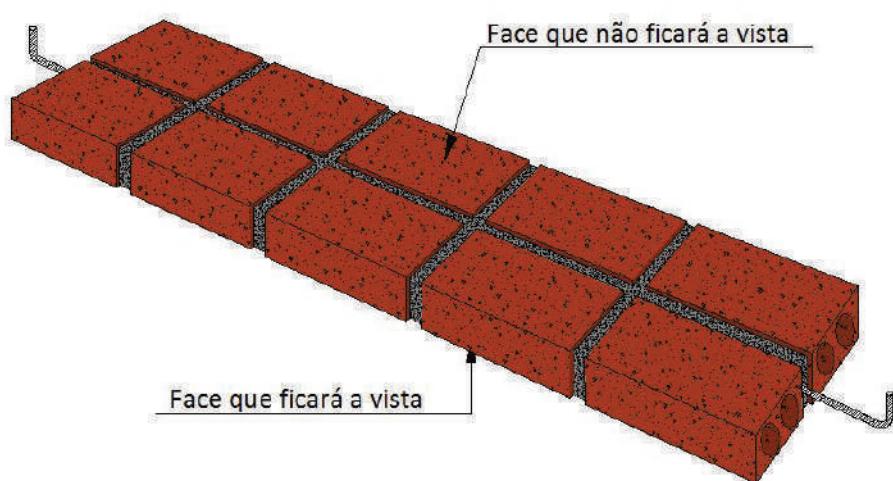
Elemento linear pré-moldado de tijolo. (*-5).
